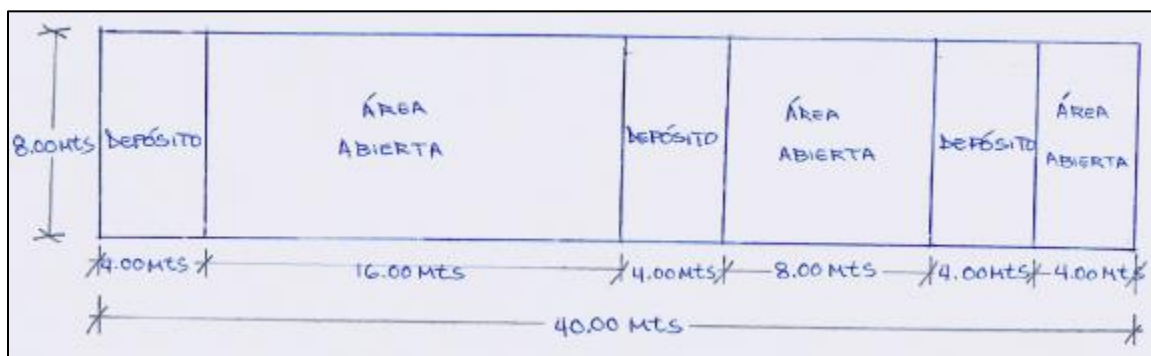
Distribución de estructuras existentes en el campamento 1.
